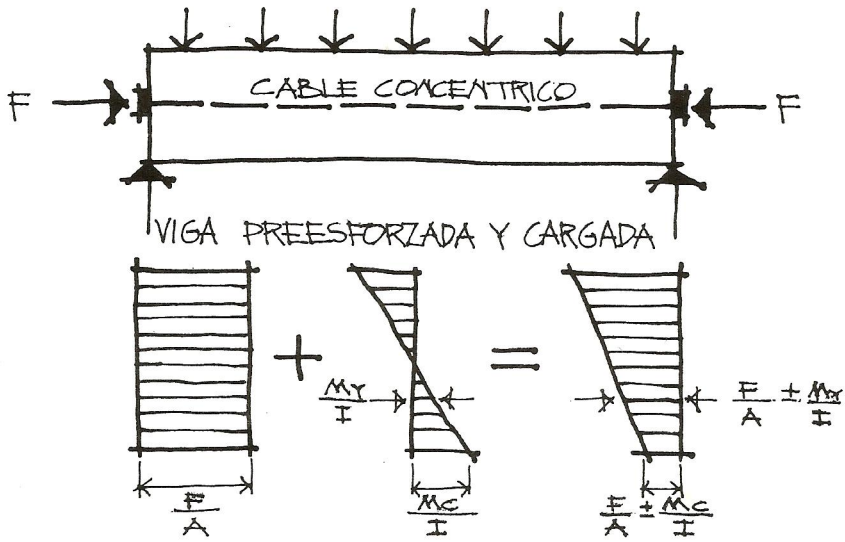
Distribución de esfuerzos en la sección transversal de concreto preesforzado concéntricamente.
